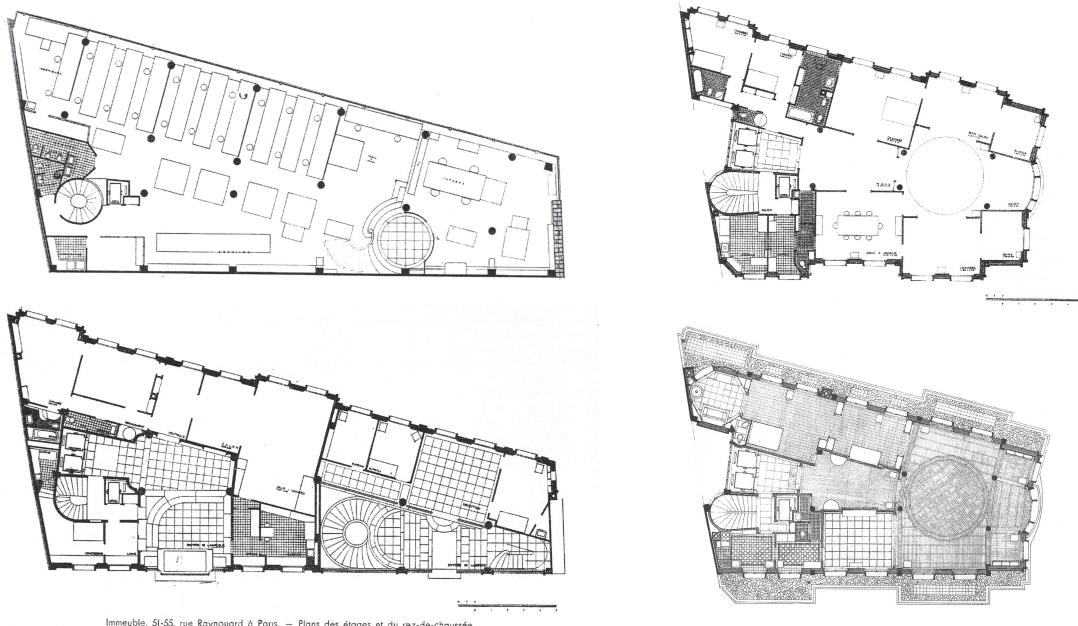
Inmueble Raynouard, plantas: oficina, planta baja, apartamentos y casa de Perret.
